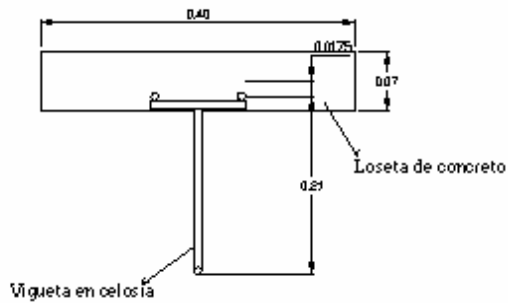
Sección transversal viguetas con el cordón a compresión embebido.
